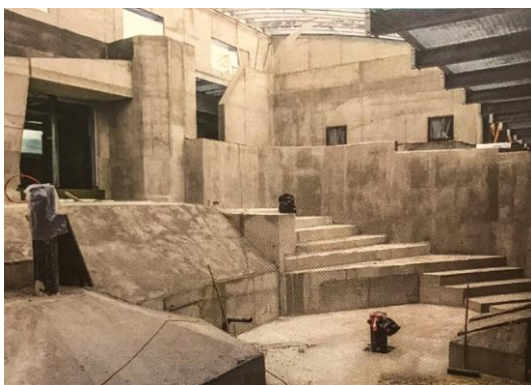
Výstavba exteriéru pavilonu<sup>[46]</sup>
